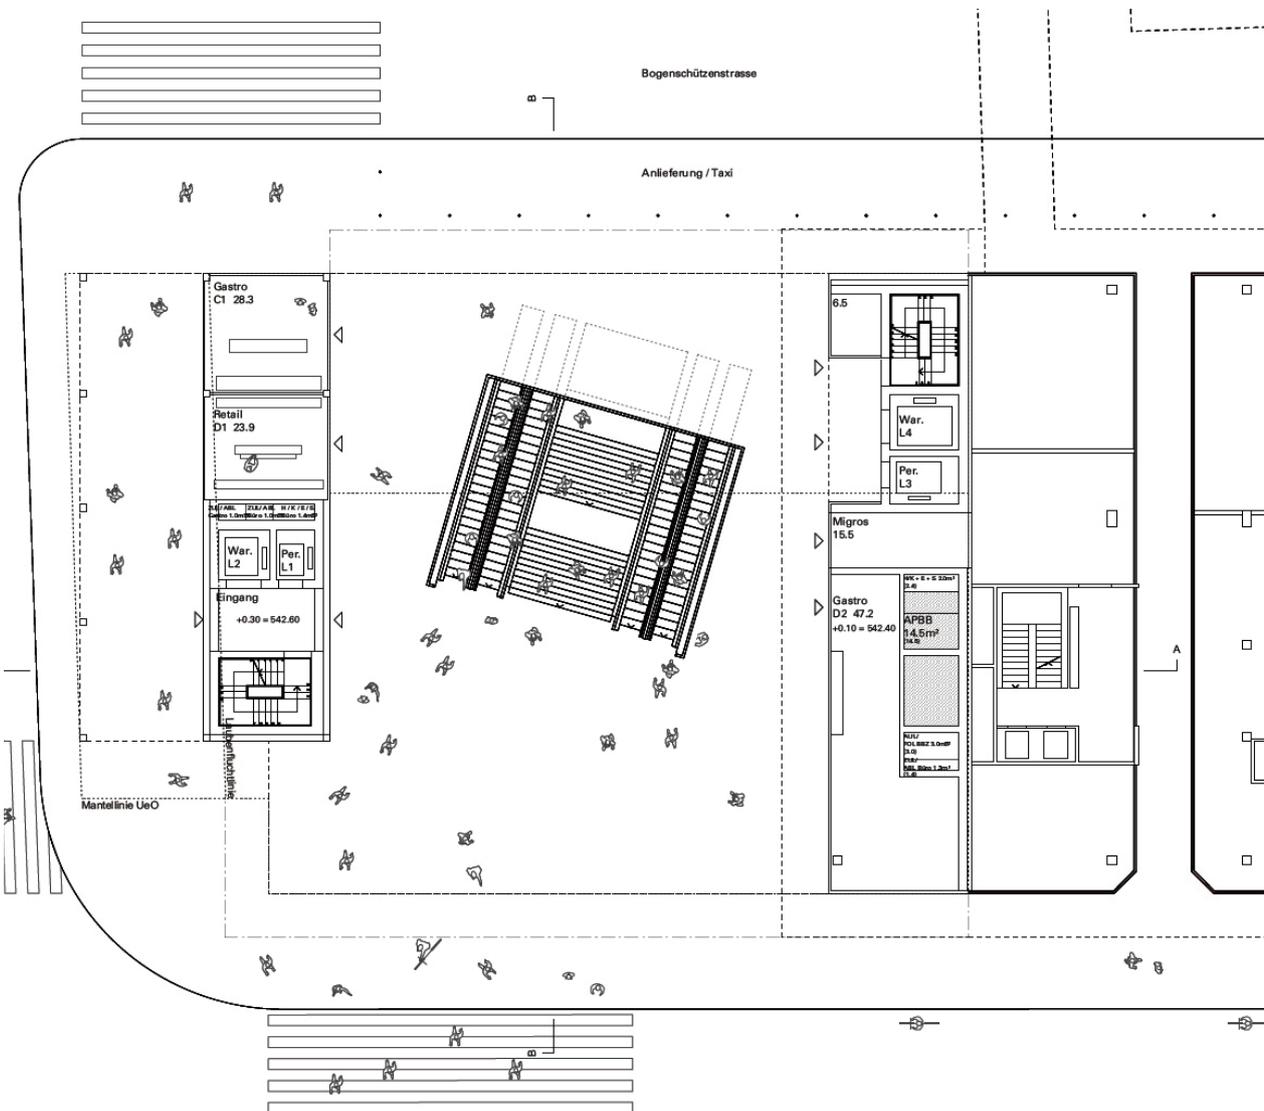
; Erdgeschoss mit öffentlichen Durchgangsbereichen
